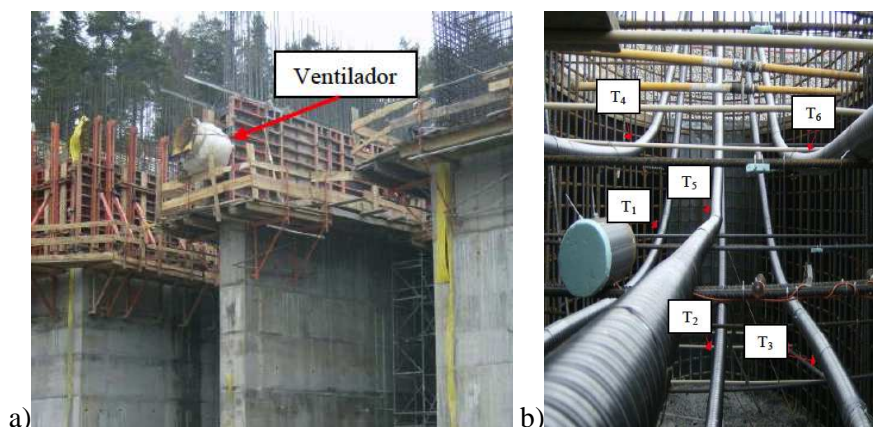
a) Foto da construção da 21ª fase com identificação do ventilador; b) Foto das bainhas de ventilação na zona do corte A-A, em perspetiva jusante/montante
